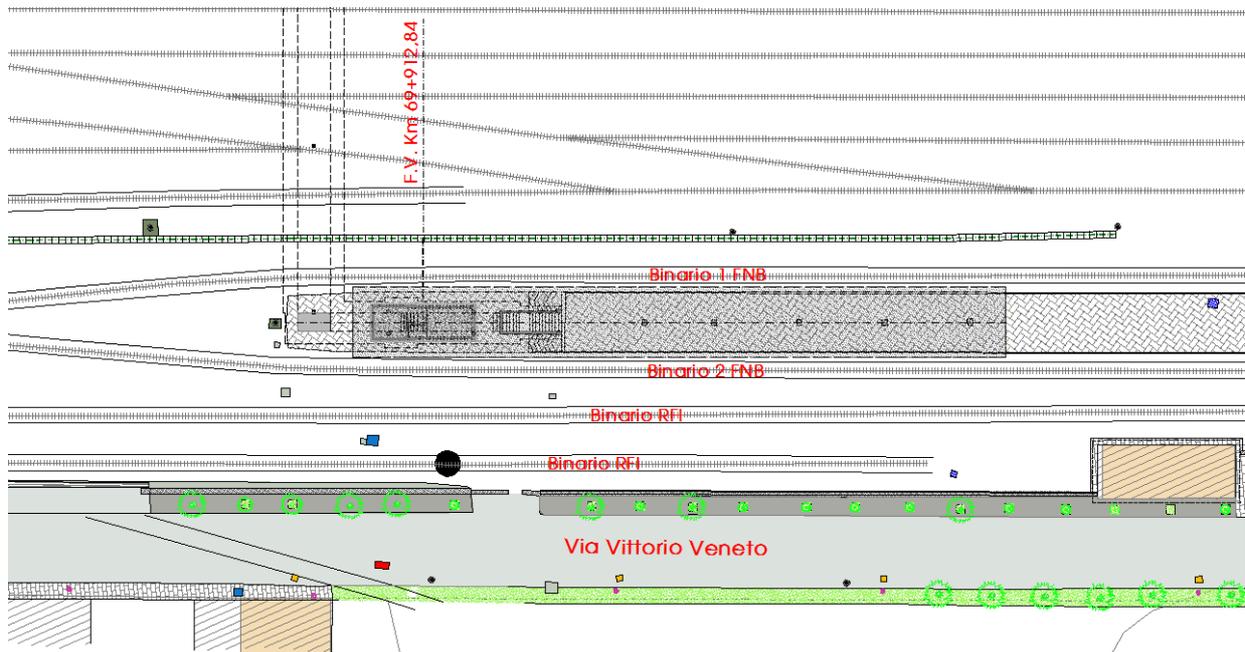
Stazione di Barletta Centrale: pianta livello banchina stato dei luoghi
